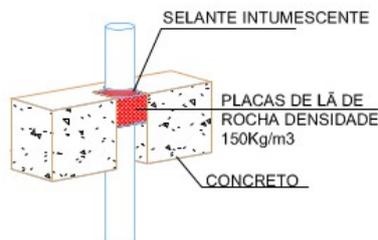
Detalhe de selagem corta-fogo junto às instalações elétricas e shafts
